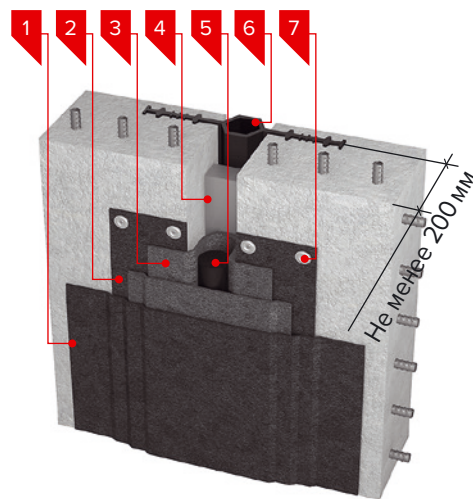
Техноэласт Фундамент ТЕРРА с механическим креплением к основанию. Обустройство вертикального деформационного шва с центральной гидрошпонкой
